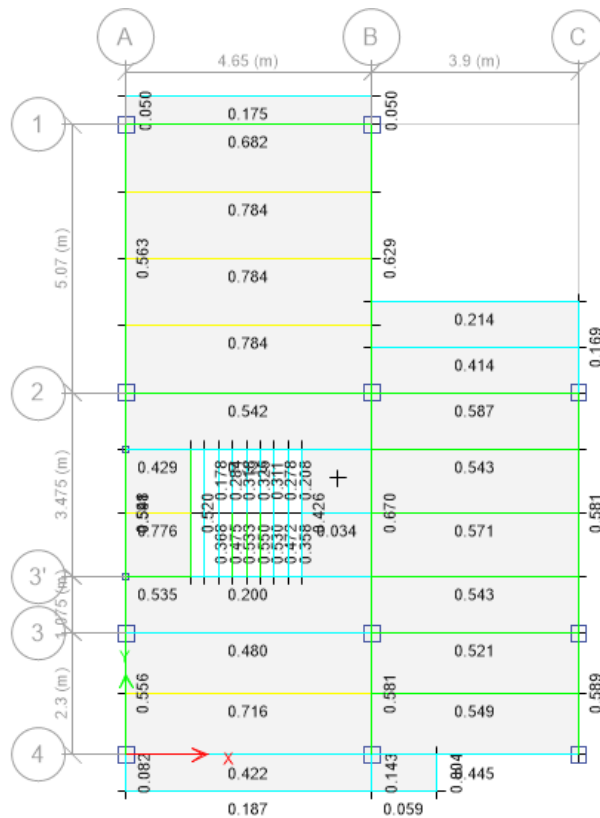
Diseño de vigas principales y secundarias de la losa del nivel +8.82
